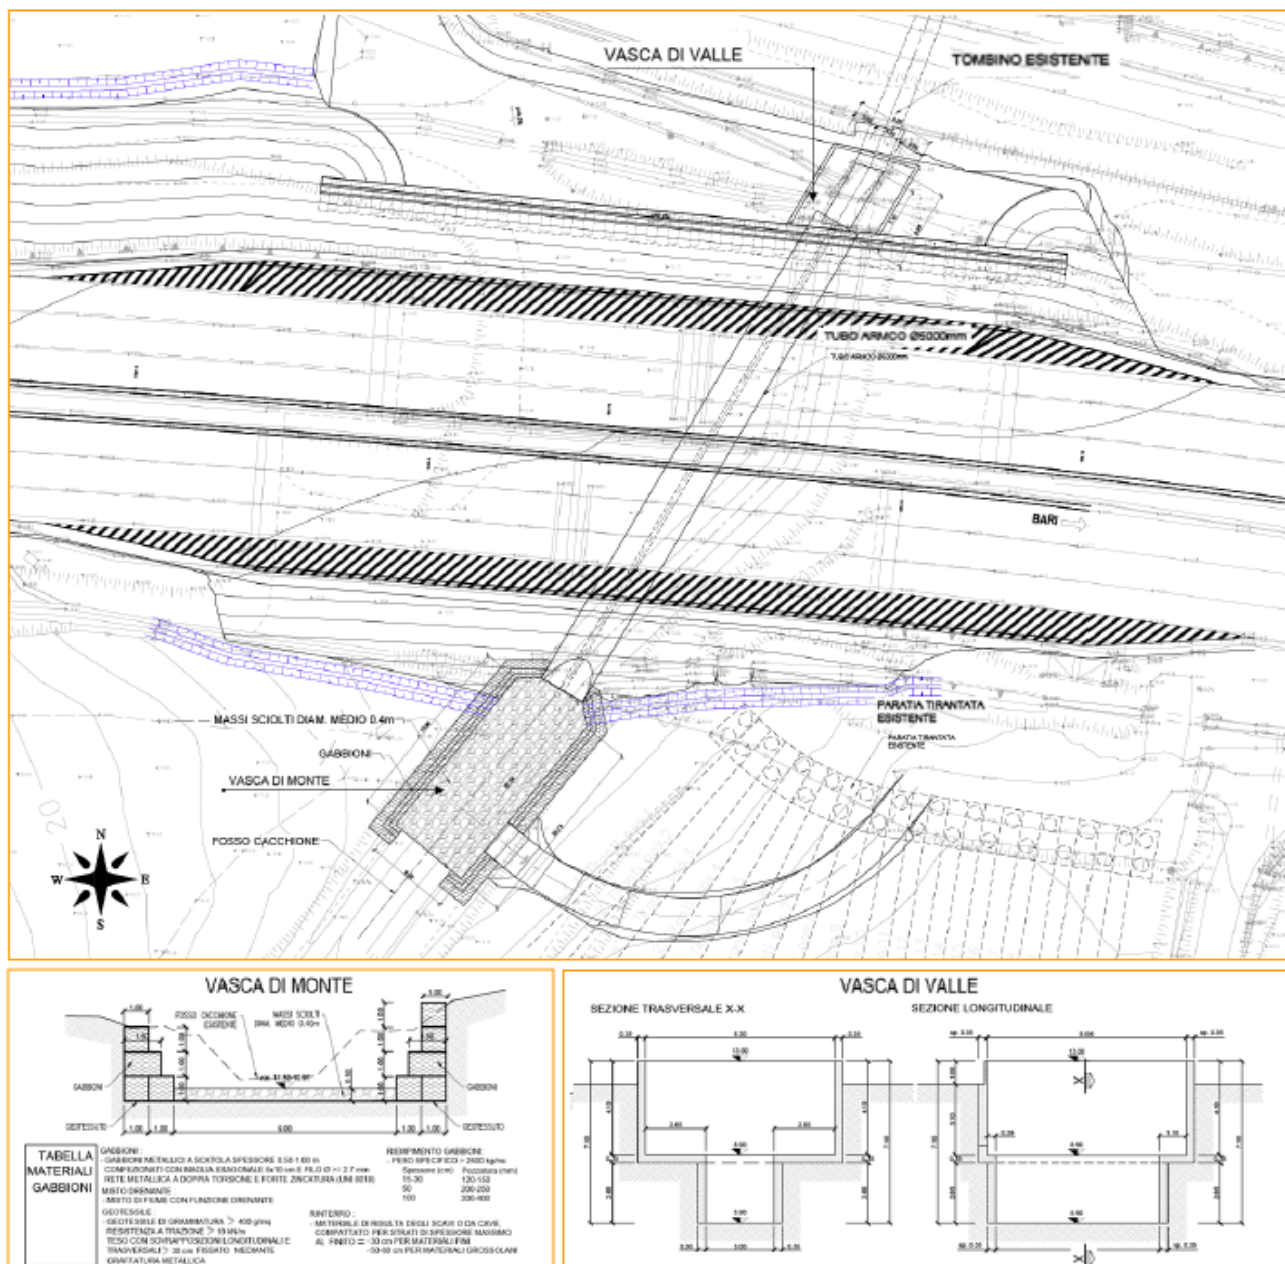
Planimetria di progetto del nuovo rilevato stradale con indicazione delle opere previste per la sistemazione idraulica del fosso Cacchione
